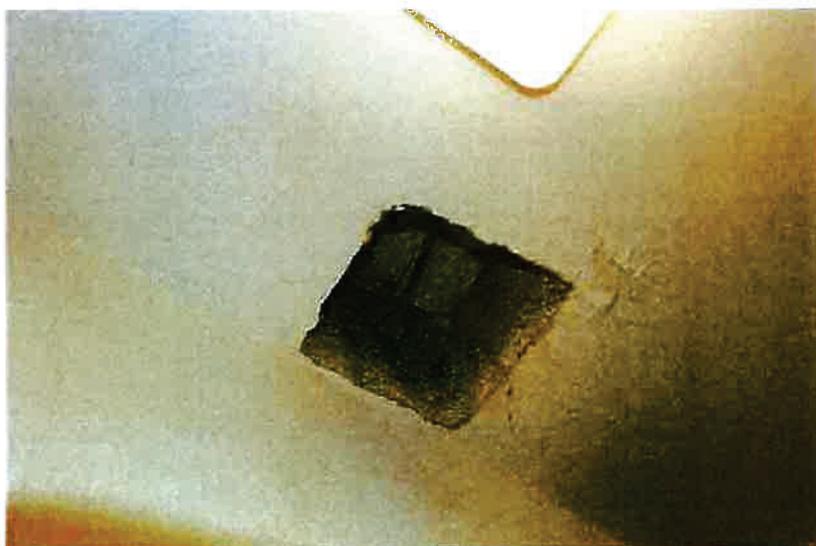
Lager Deckendurchbruch Stahlbetondecke
